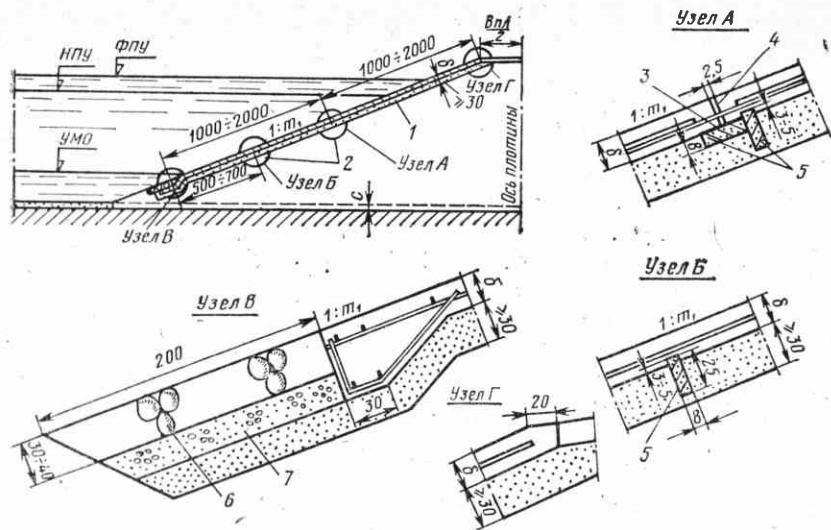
Крепление верхового откоса из монолитного железобетона:
